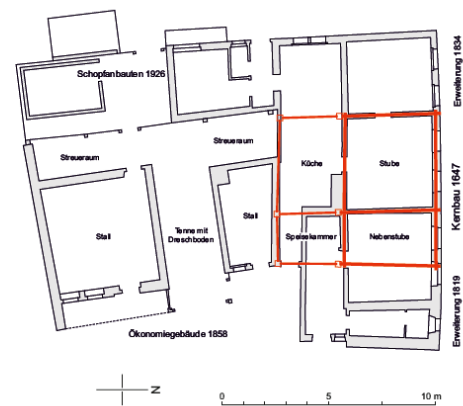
Grundriss Erdgeschoss, 1:200.
